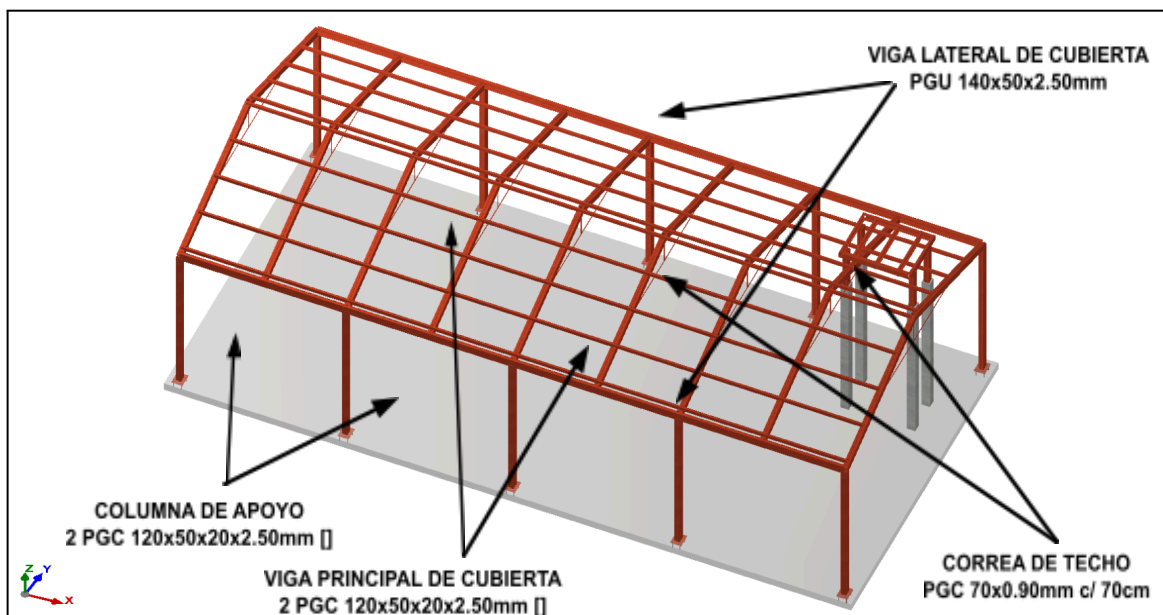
Esquema estructural de cubierta y sostén metálico.
